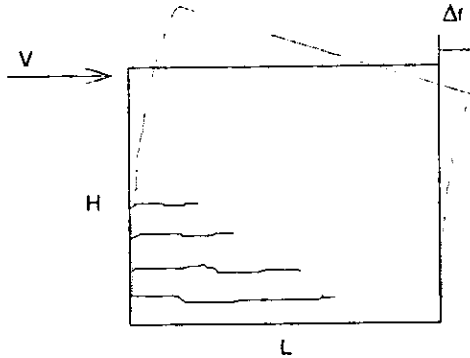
Agrietamiento y elástica de la deformación en un muro debidas a flexión.
